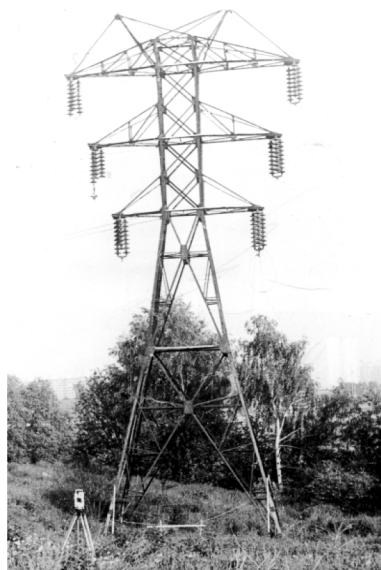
Исследование совместной работы конструкций и основания анкерно-угловой опоры типа УМ-102 для ВЛ 110 кВ (Москва, Орехово-Борисово, 1980) при ее ресурсных испытаниях с замером перемещений монолитных фундаментов и усилий в поясах и раскосах (ОРГРЭС-Союзтехэнерго, 1980)
